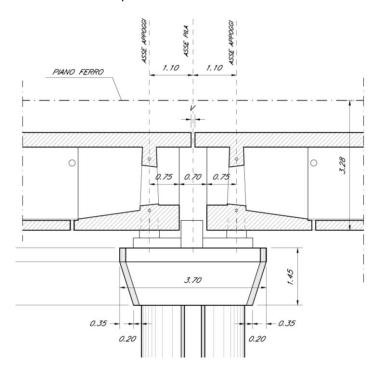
Pila, prospetto longitudinale - Due impalcati CAP
